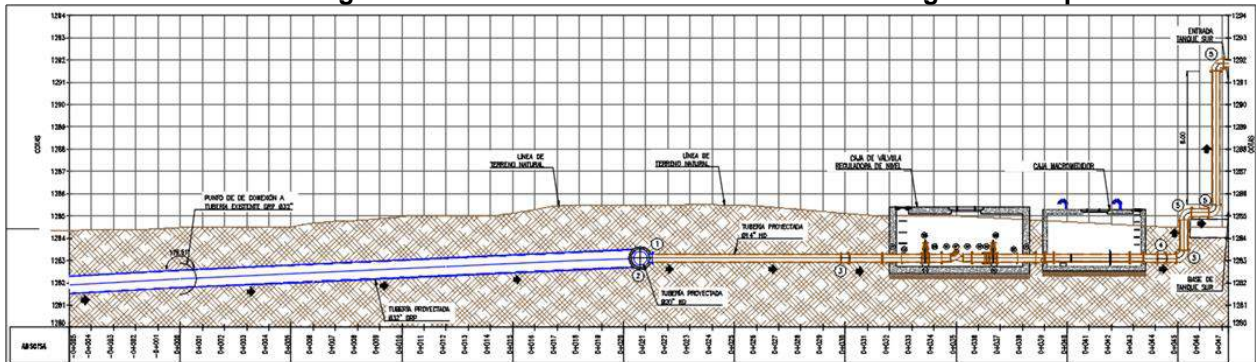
Planta general alineamiento llegada a tanque sur y cajas especiales
